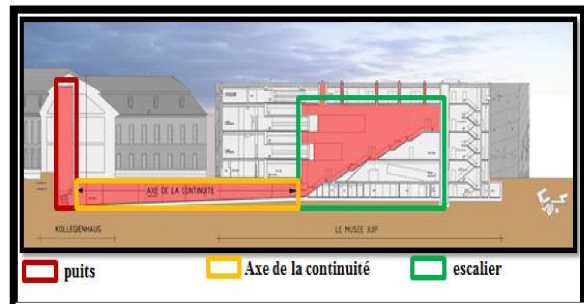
Coupe sur l'entrée, l'axe de la continuité et l'escalier
